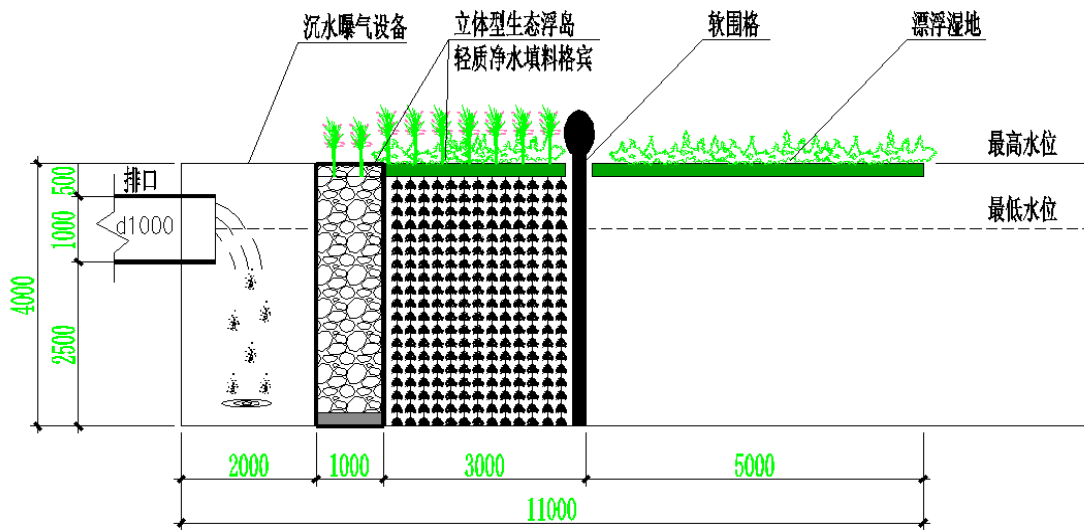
雨水排水口生态拦截设施剖面图
